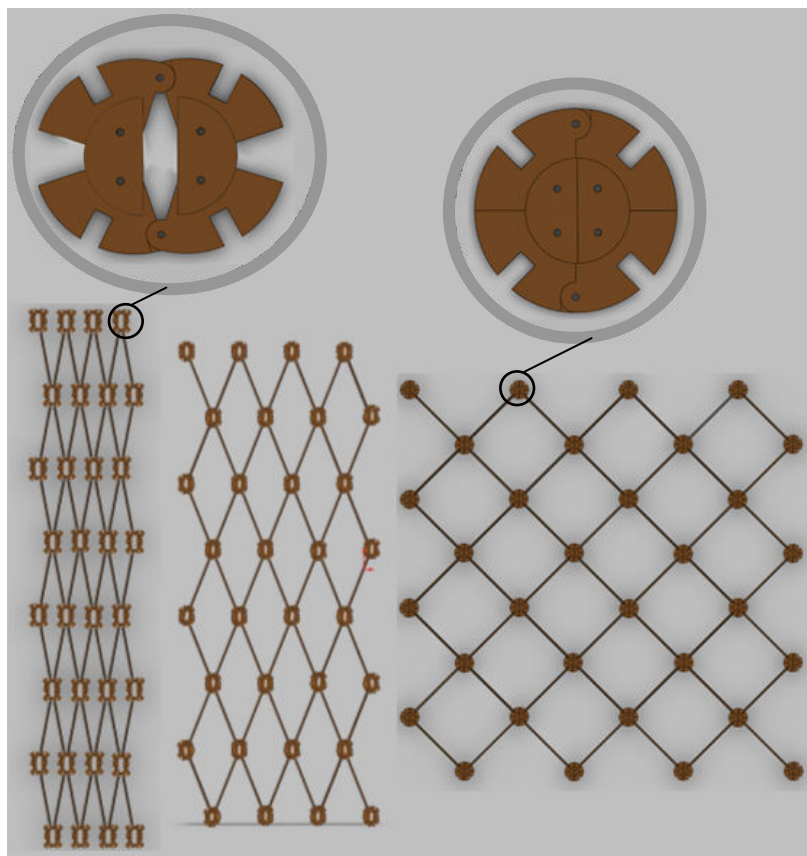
Articulação da Estrutura III com detalhe para a geometria do elemento de conexão (autor, 2010).
